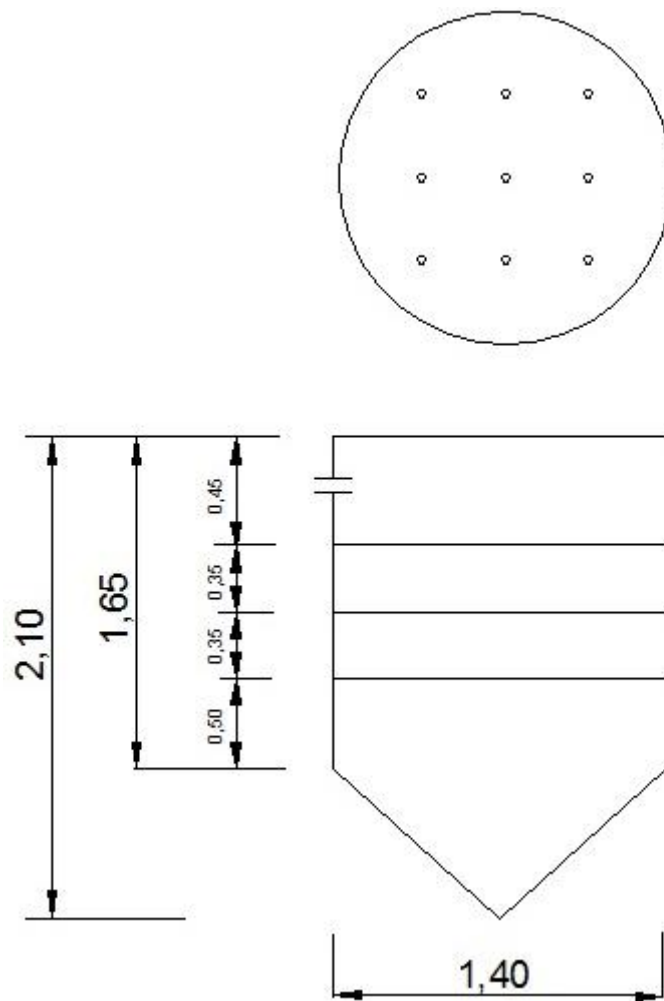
Corte e planta do floculador de bandejas perfuradas (medidas em metros)
